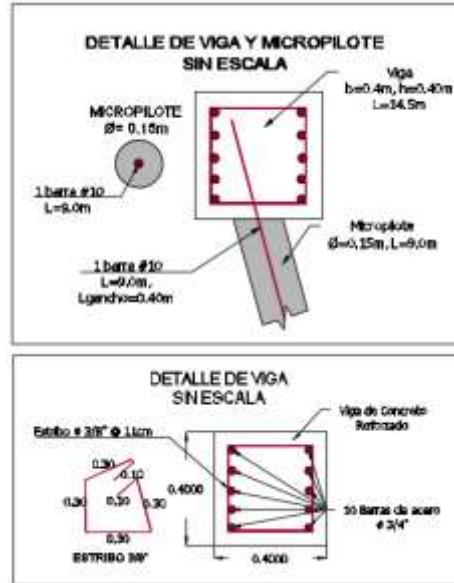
Detalle de viga y micropilotes - Proyecto San Agustín
